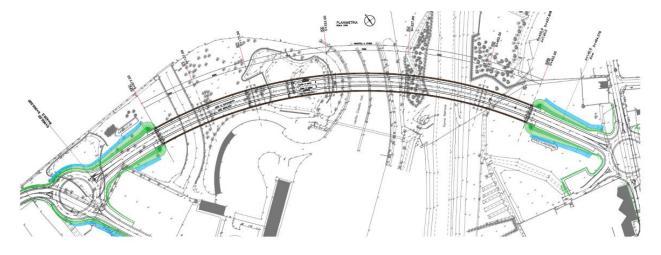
Ponte sul F. Retrone – Inquadramento planimetrico.
